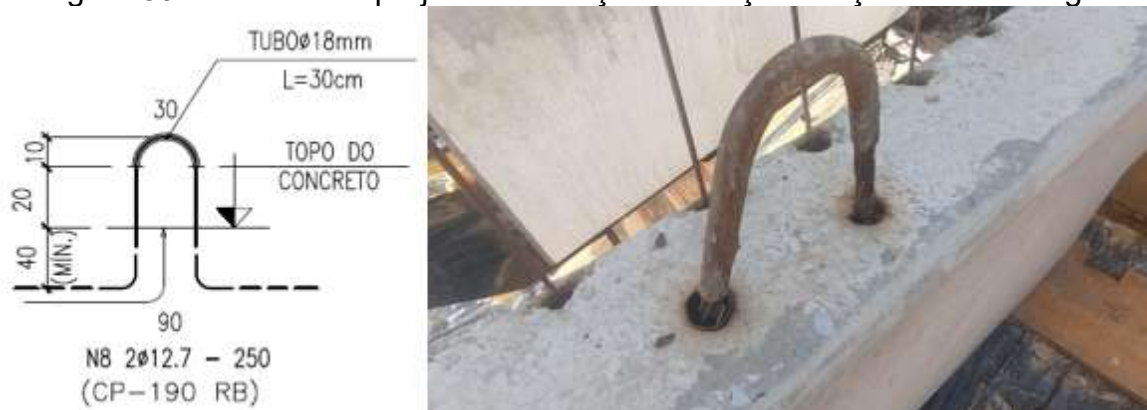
Detalhe do projeto e execução das alças de içamento das vigas
